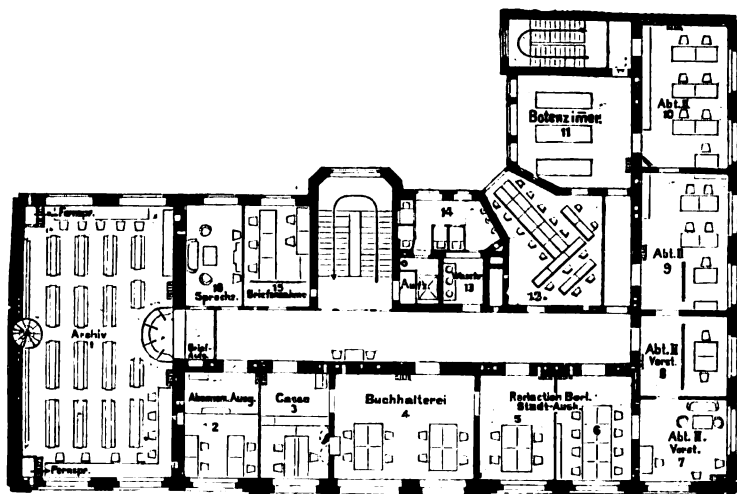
Grundriss des ersten Stockwerks.
